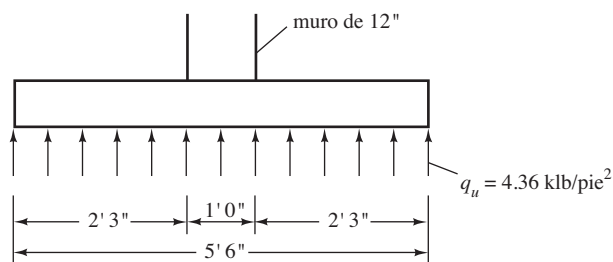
Zapata de concreto simple para el Ejemplo 12.10.
